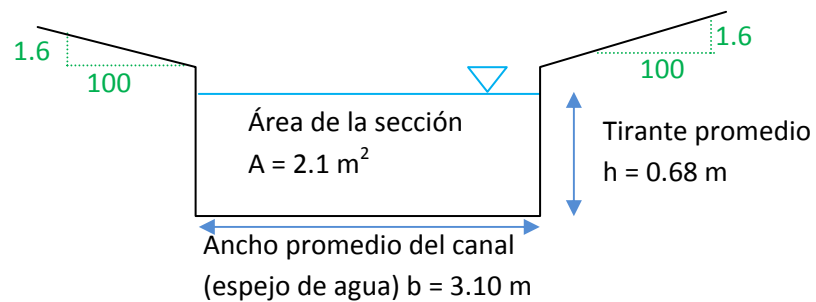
Secciones transversales levantadas el 5 de agosto de 2011.
